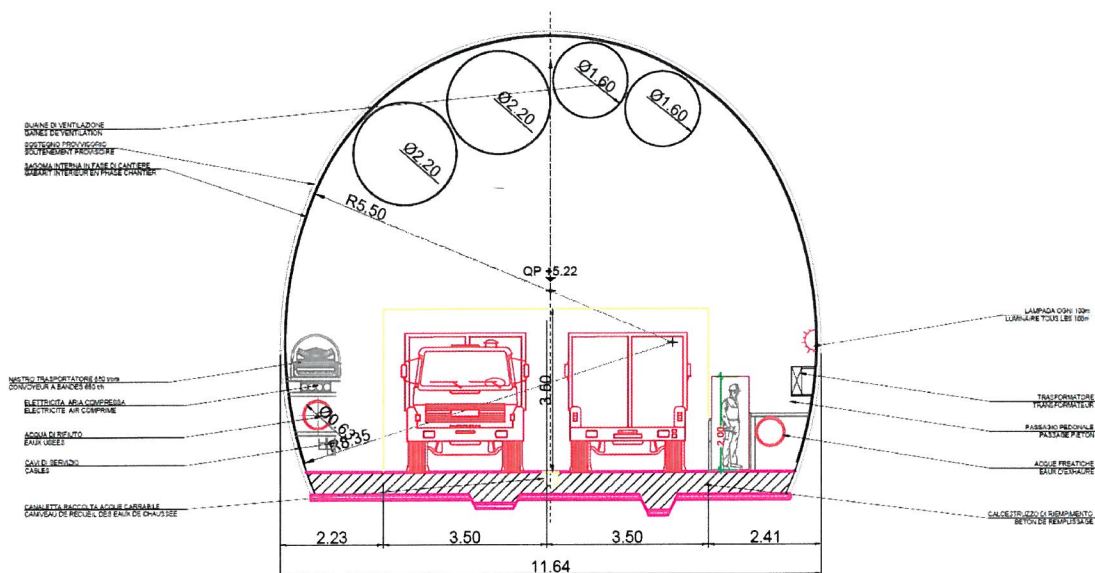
Sezione galleria intertubo con sala d'accoglienza
